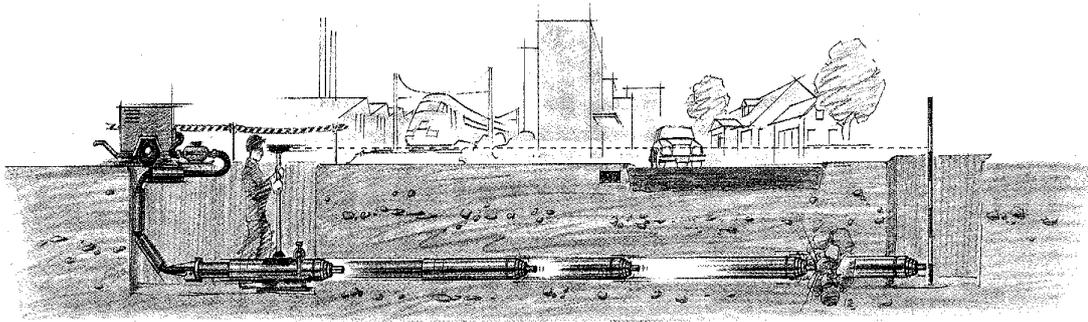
Bodenverdrängungsverfahren – Bodenrakete [2]
